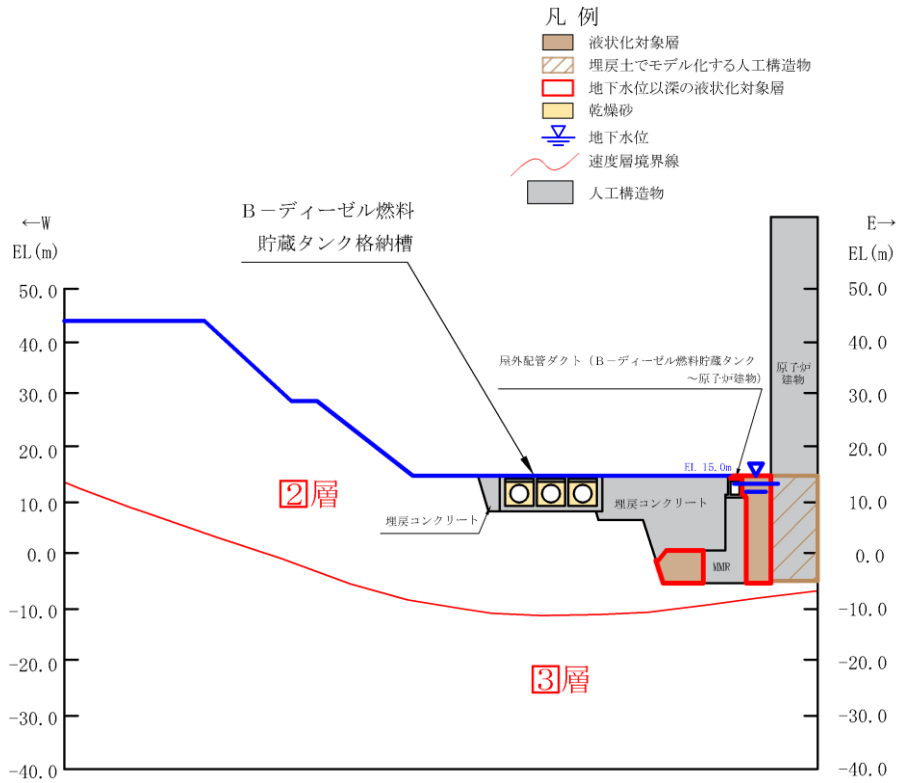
B-ディーゼル燃料貯蔵タンク格納槽 評価対象断面図 (A-A 断面)
